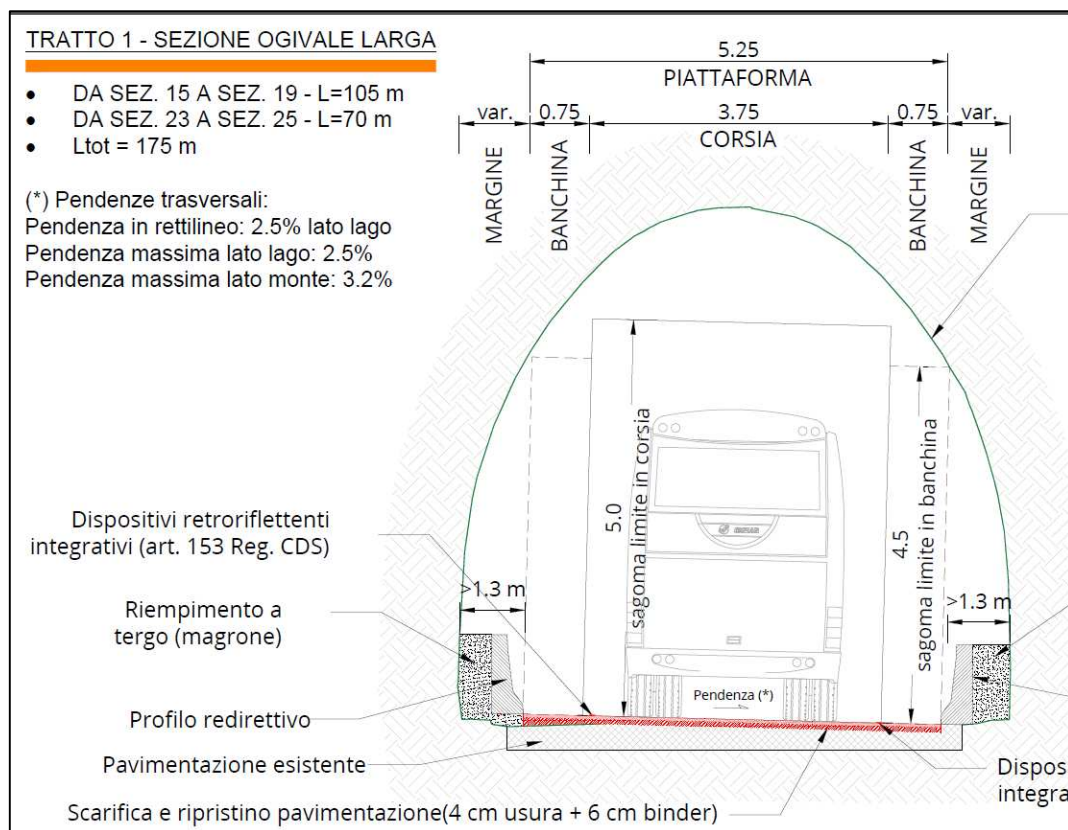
Sezione tipo adeguamento galleria esistenti.
